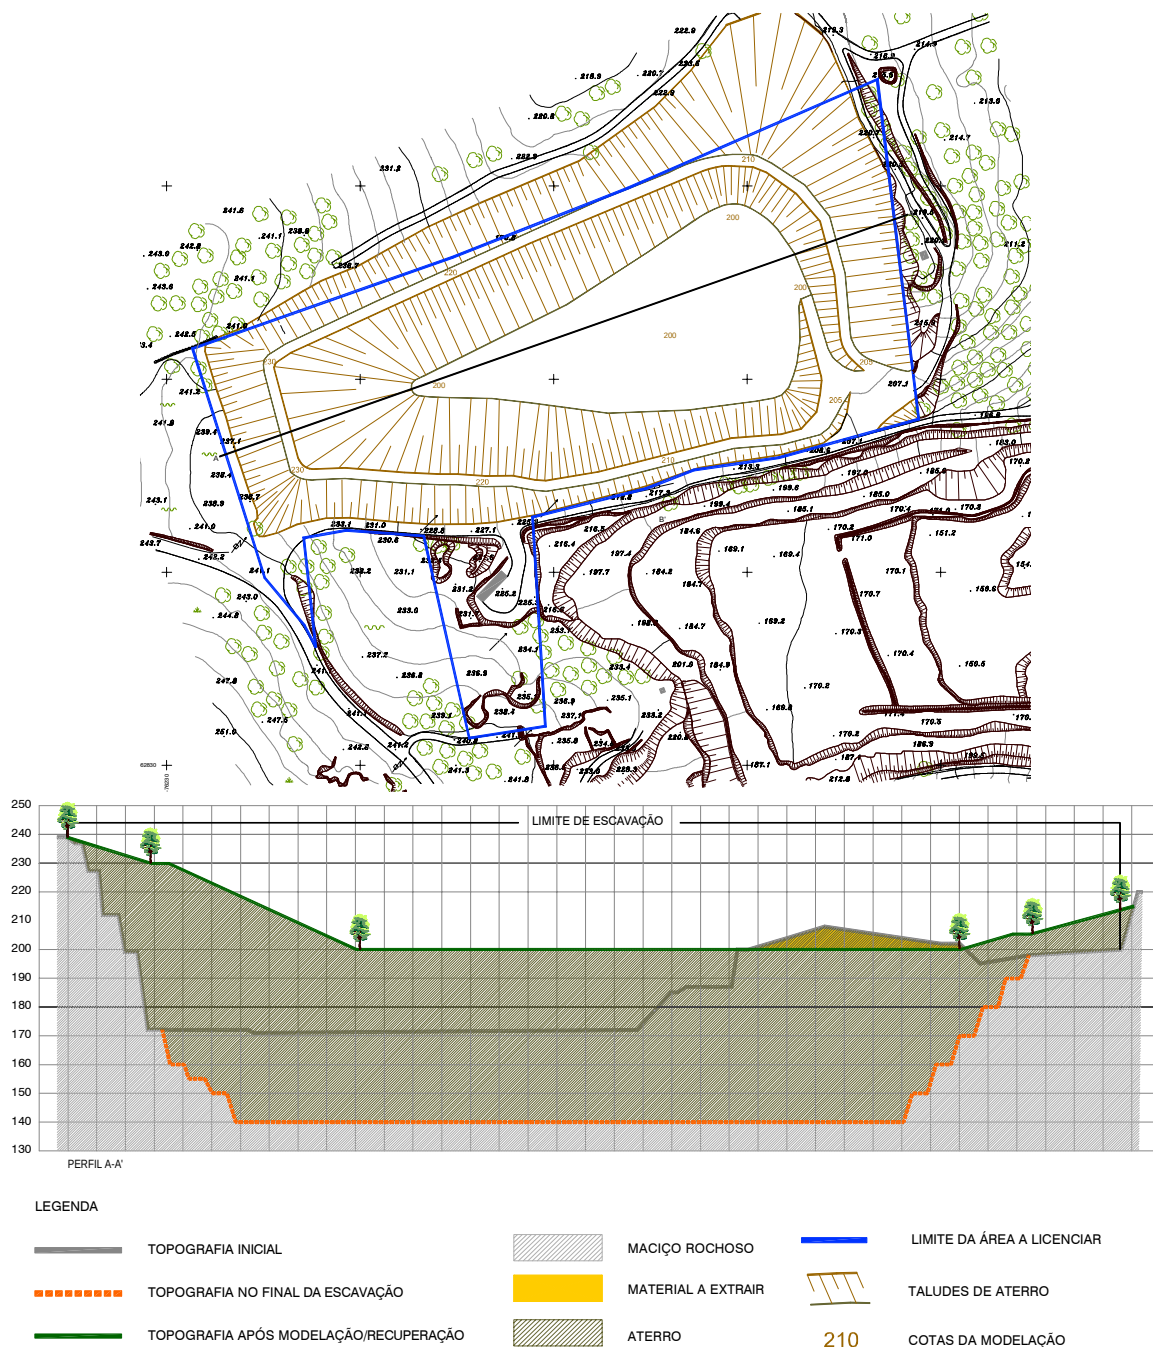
Planta e perfil longitudinal do aterro previsto para a pedreira "Courela da Serra".
